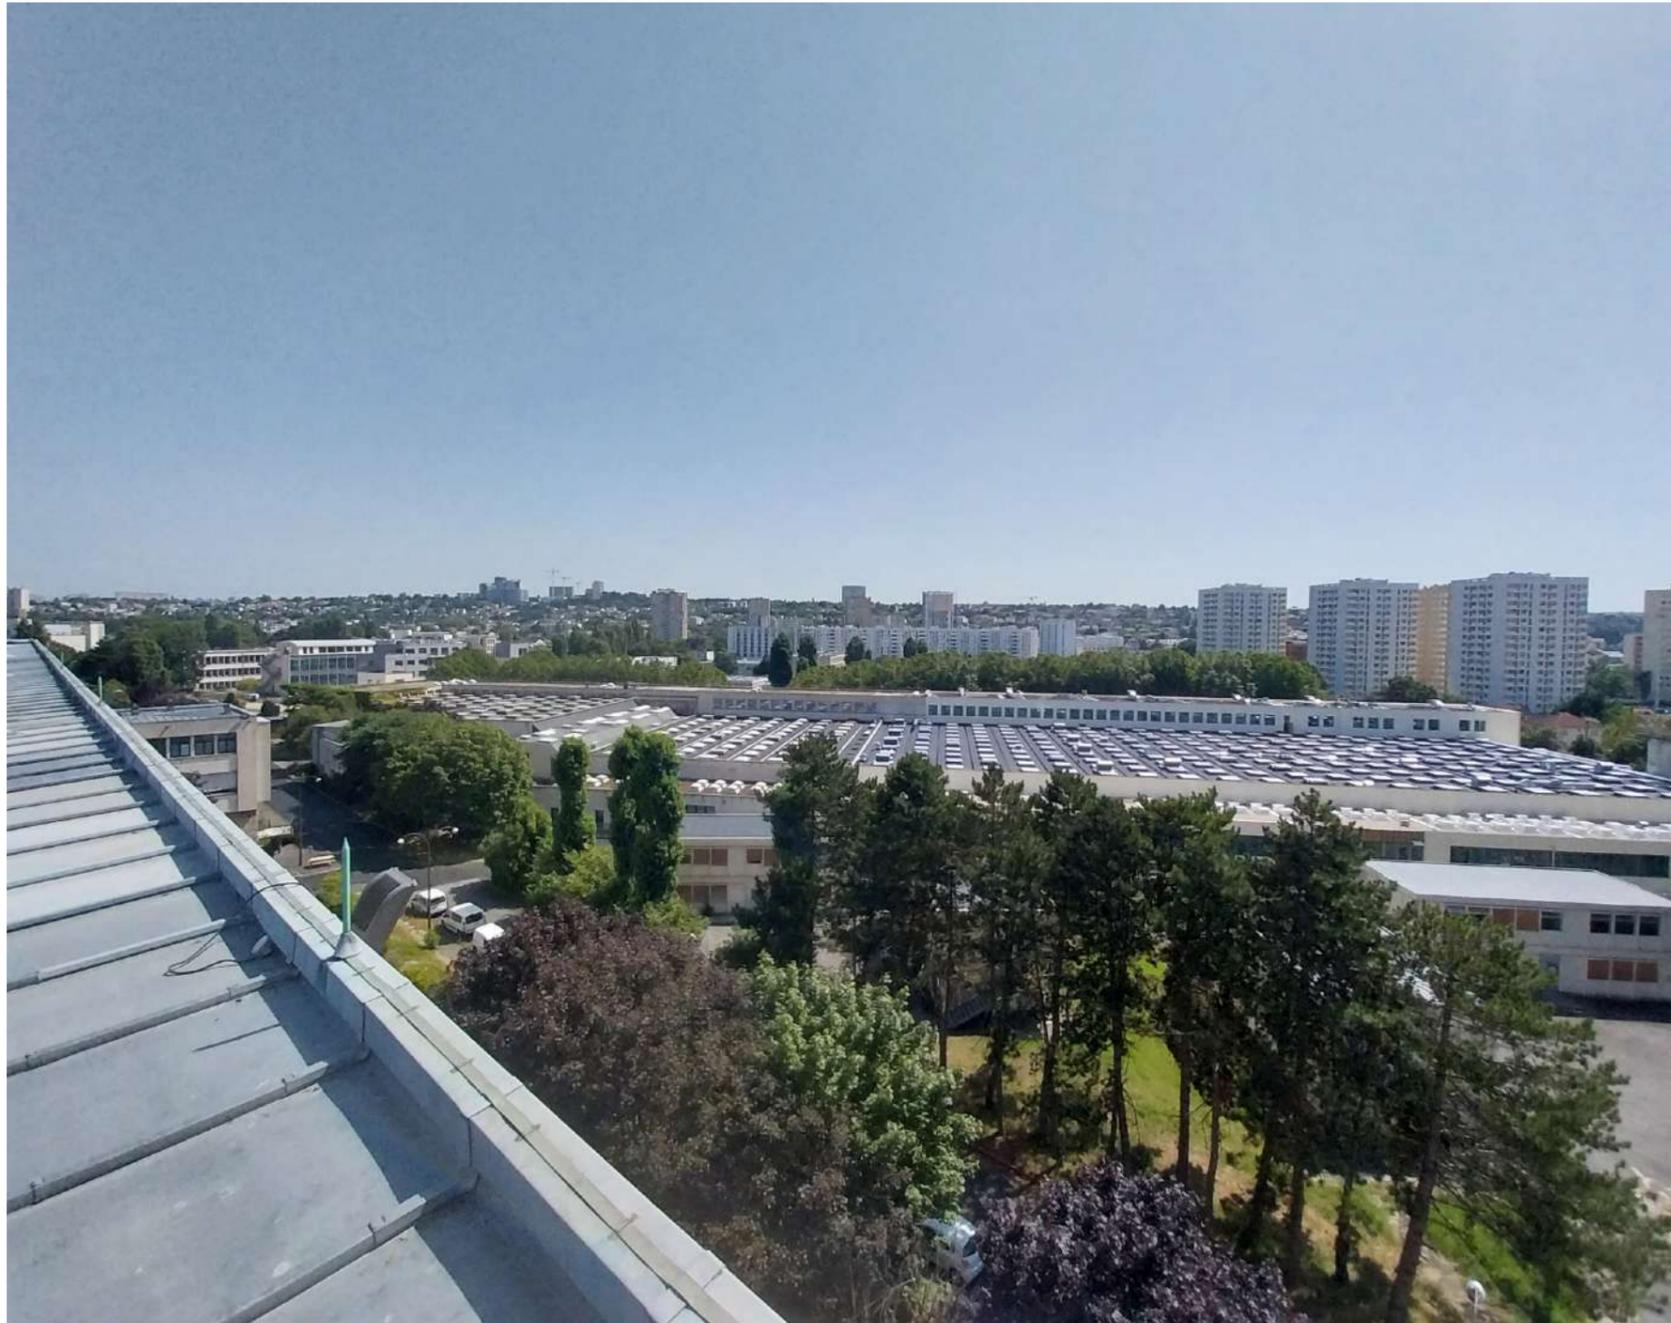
PRISE LE 30/07/2024 DEPUIS LA TOITURE DU BATIMENT SORRE
